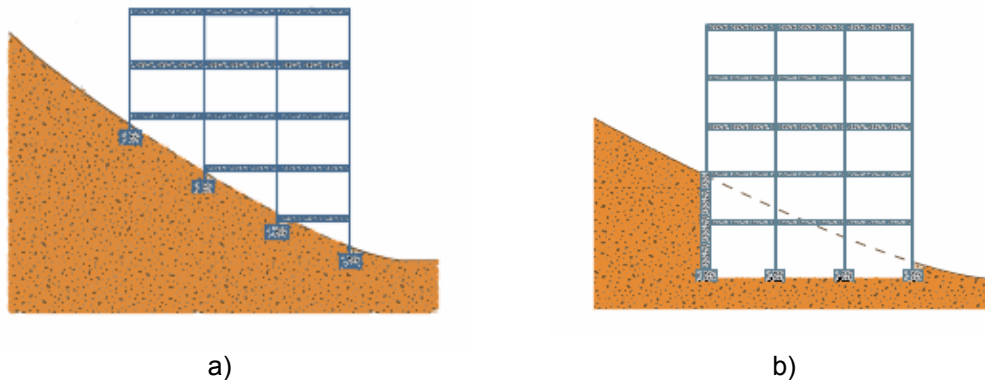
Implantação em terreno inclinado: a) Fundações adaptadas à cota do terreno e b) Pilares construídos sobre parede de contenção.
